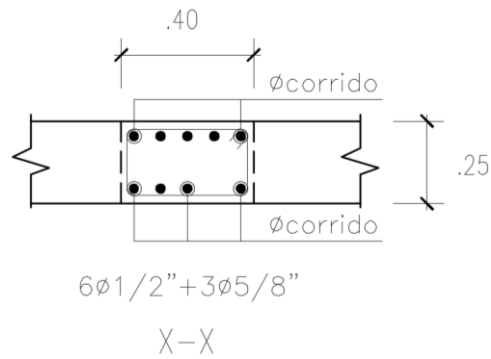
Corte de detalle para la colocación de acero en viga chata VCH-01.
